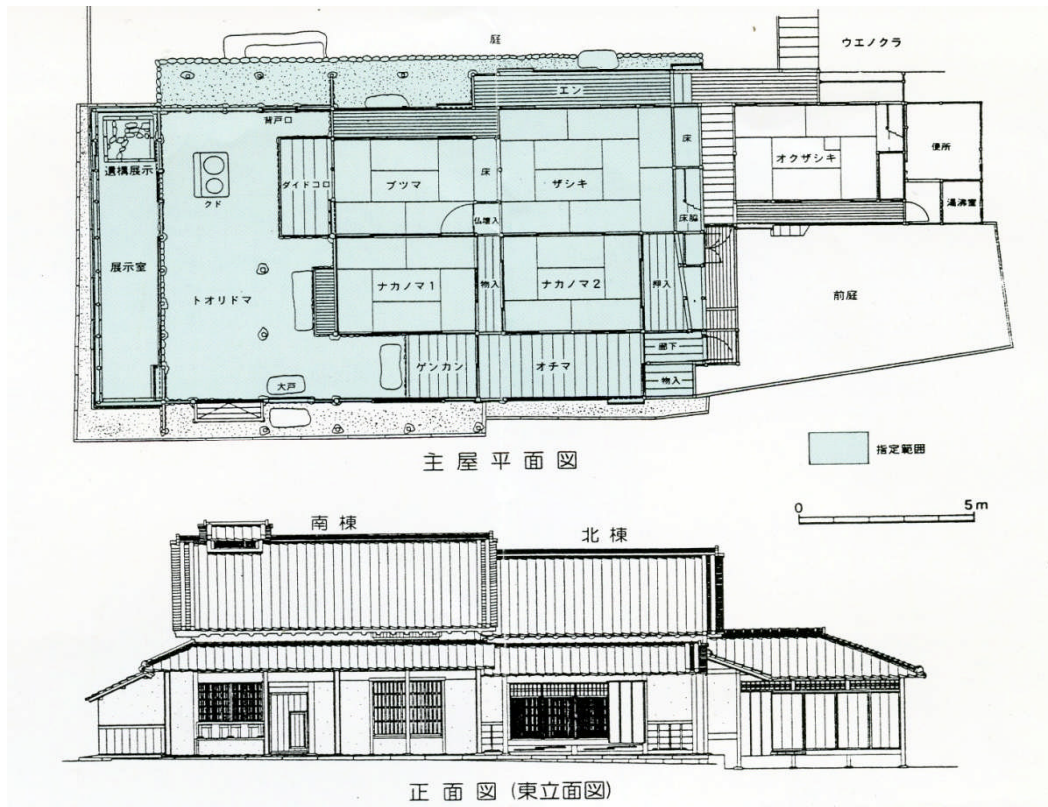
須田家住宅主屋平面図・正面図（東立面図）
